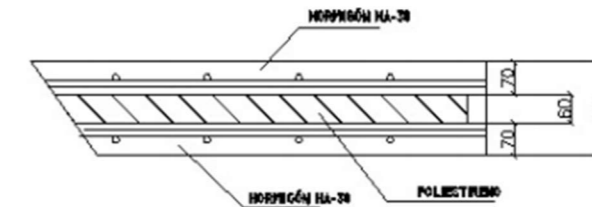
Sección paneles de hormigón prefabricado aligerado.
